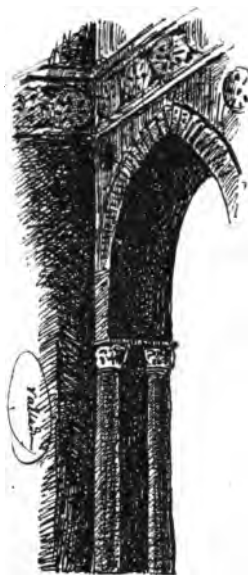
Pilar con columnas de la mezquita de Tulum.
